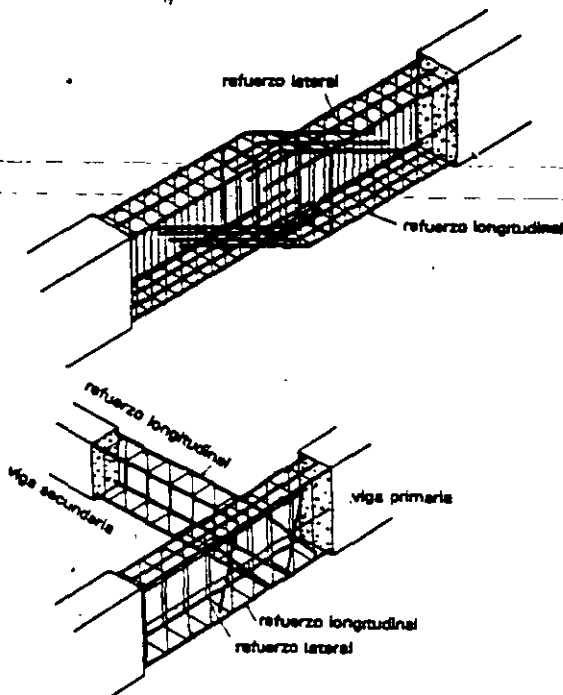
Detalle de refuerzo en viga con desnivel y del apoyo de una viga secundaria en una primaria
